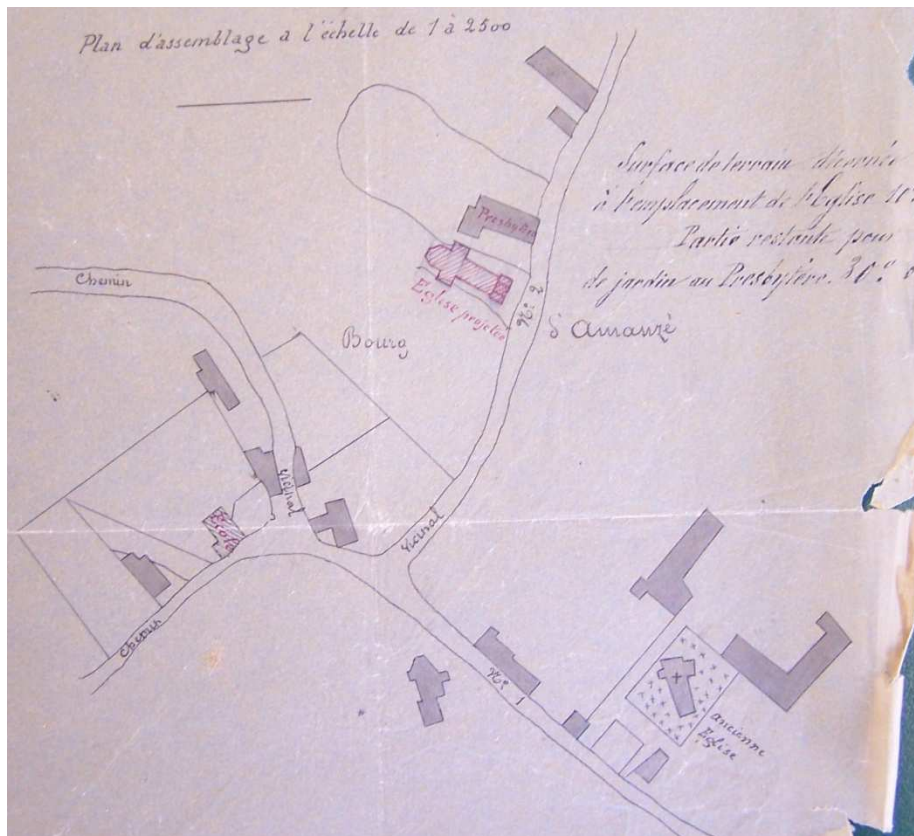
Plan dressé en vue de la construction de la nouvelle église (ADSL – O27).
